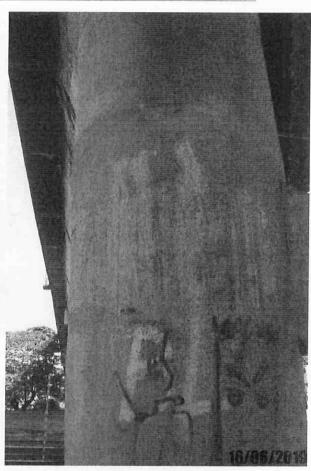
Detalhe de pequenas fissuras e eflorescência.
